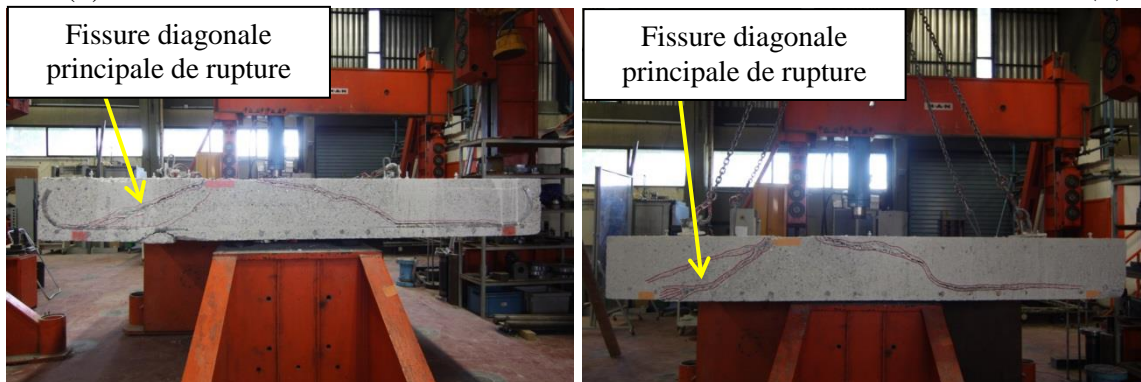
Mode de rupture 2D: a) dalle S9 coupe transversale; b) dalle S10 coupe transversale
